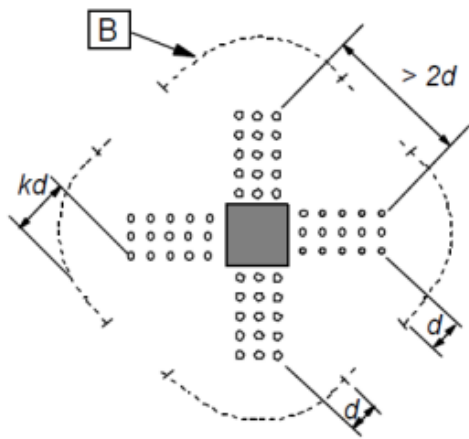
Planta de tipos de armado de punzonamiento (Instrucción de Hormigón Estructural (EHE-08), 2008).
